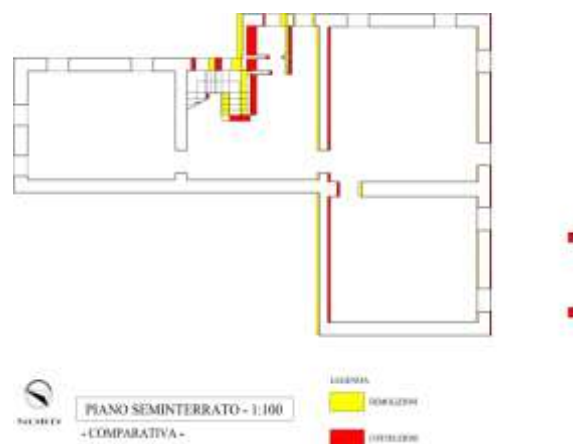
Planimetria P.Semint. con evidenziate demolizioni e costruzioni effettuate (fuori scala) – ([Allegato N.2](#))
